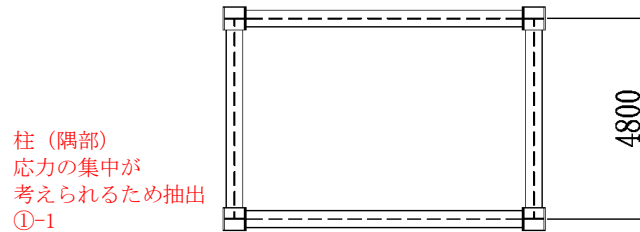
非常用ガス処理系配管支持架構の概略平面図 (EL. 14.2 m)
